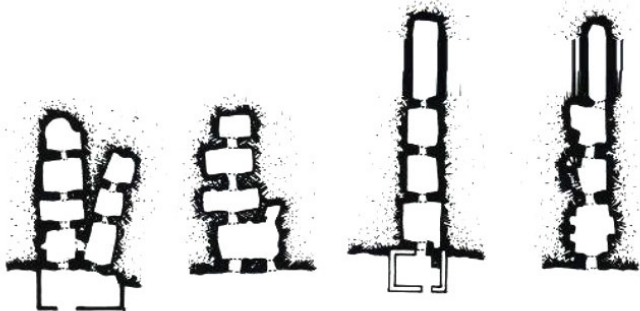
Planta de cueva en Pegalajar. Jaén. España.
